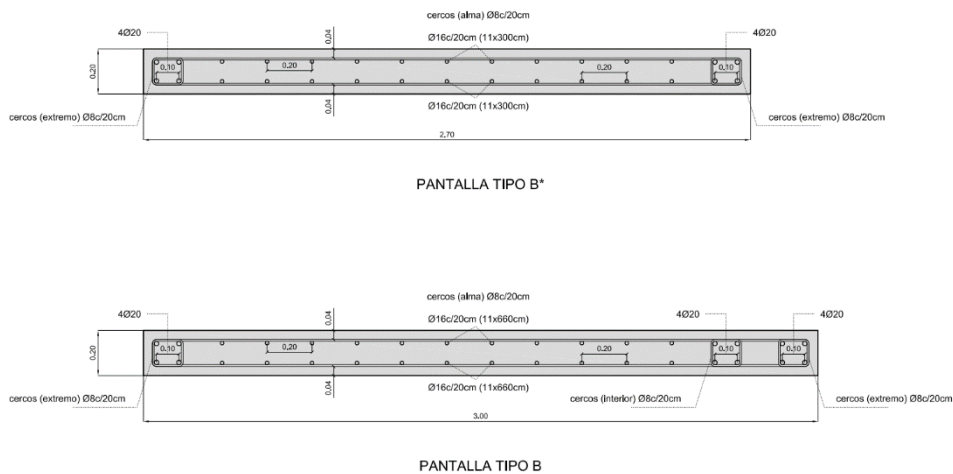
Sección de muro M.02 y M.03 con armado, en tramo superior e inferior. Fuente: David Gallardo.
